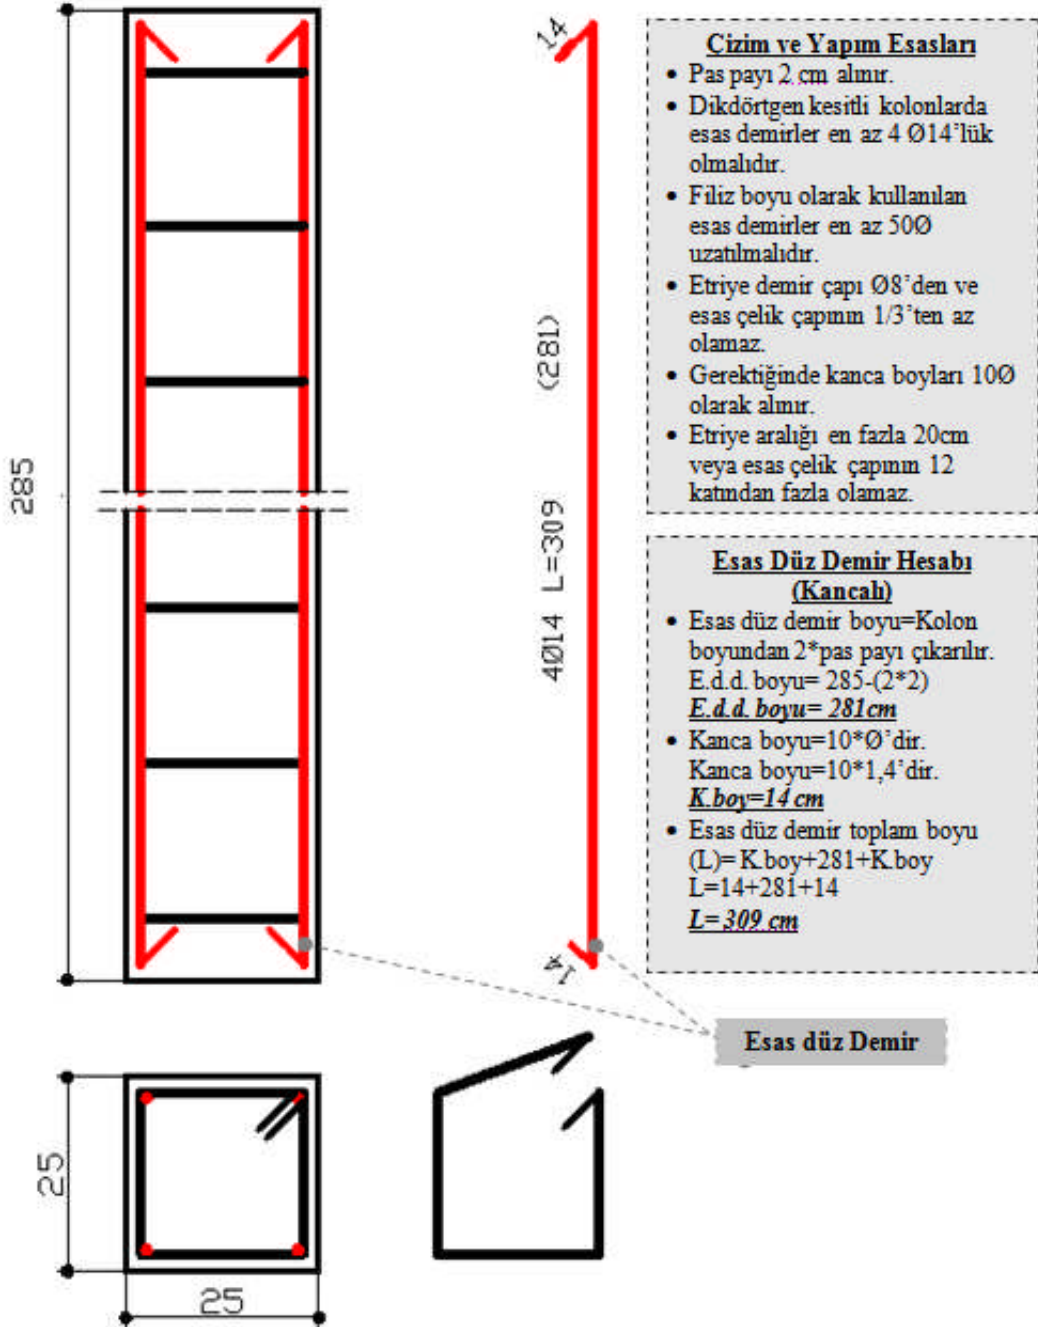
Esas demirin kullanıldığı çeşitli betonarme donatı elemanları
